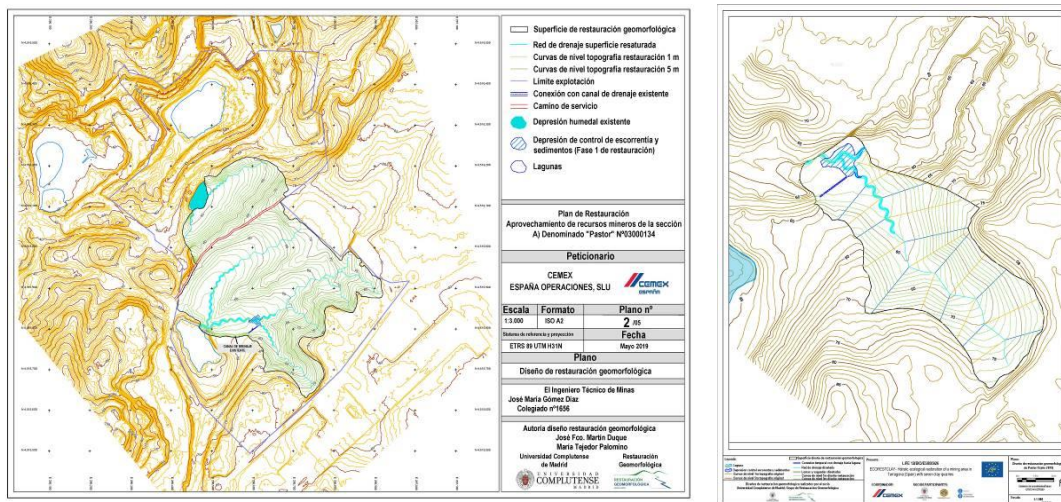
Planos de los diseños de la arcillera Pastor II. Conjunto (izquierda) y detalle del sector construido dentro de ECORESTCLAY (derecha). Los planos se incluyen como entregables.
